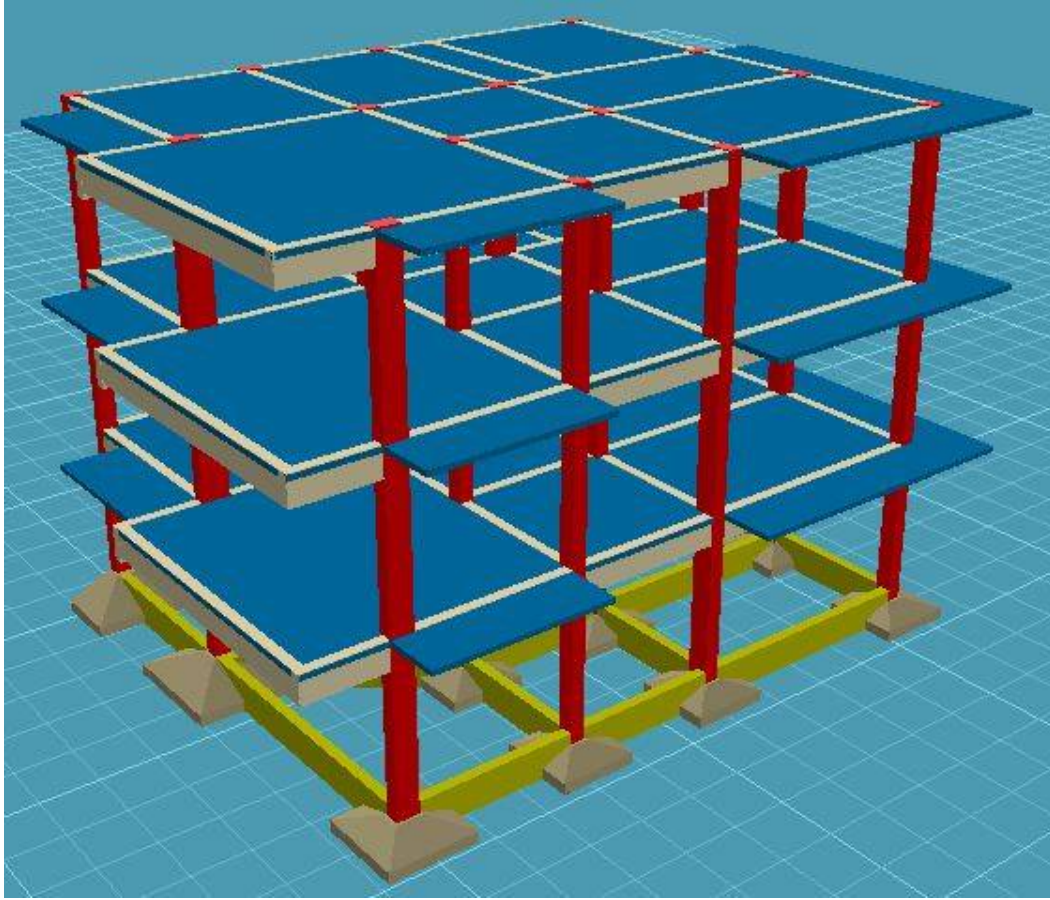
(6) Nolu bina modelleme kat planı
